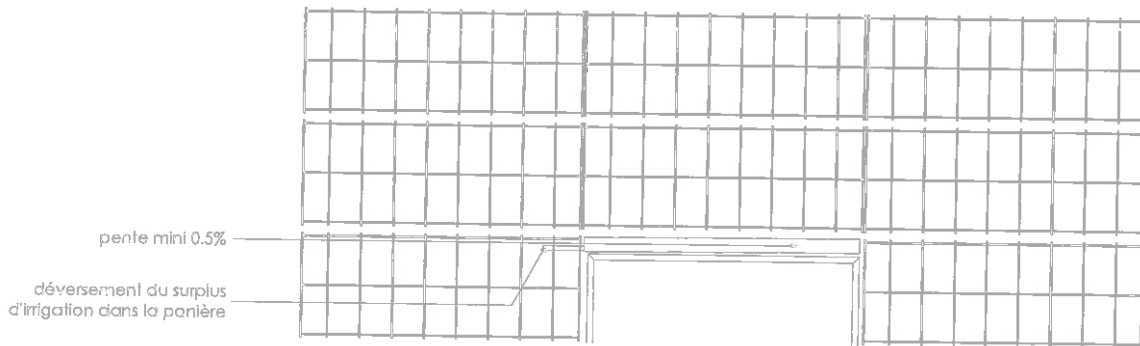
Jonction avec tableau de baie - Fixation au support par consoles
